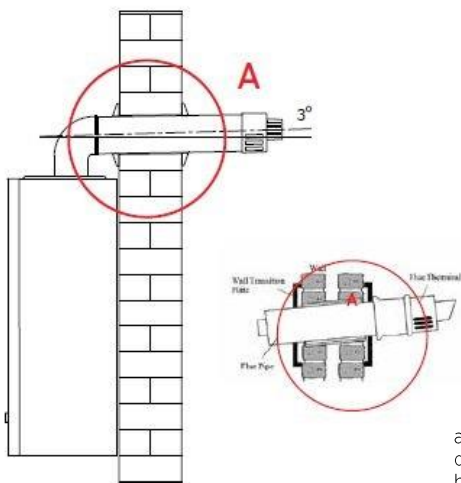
I. Przykładowa instalacja przewodu spalinowego z zastosowaniem pojedynczego kolanka pod kątem 90°.
